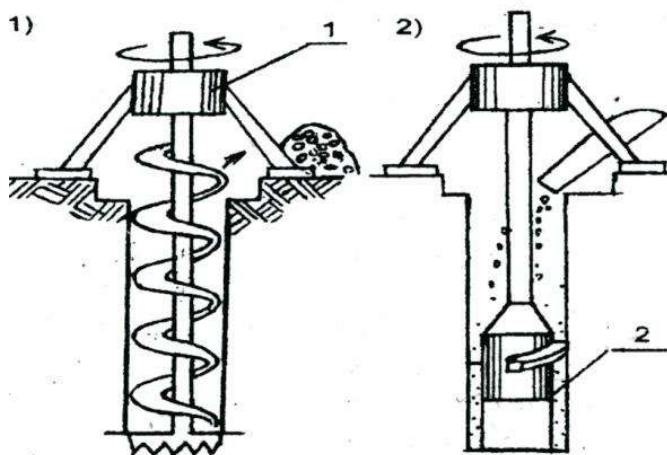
Змінні насадки. 1 - бурова насадка, 2 – пресуюча насадка.
